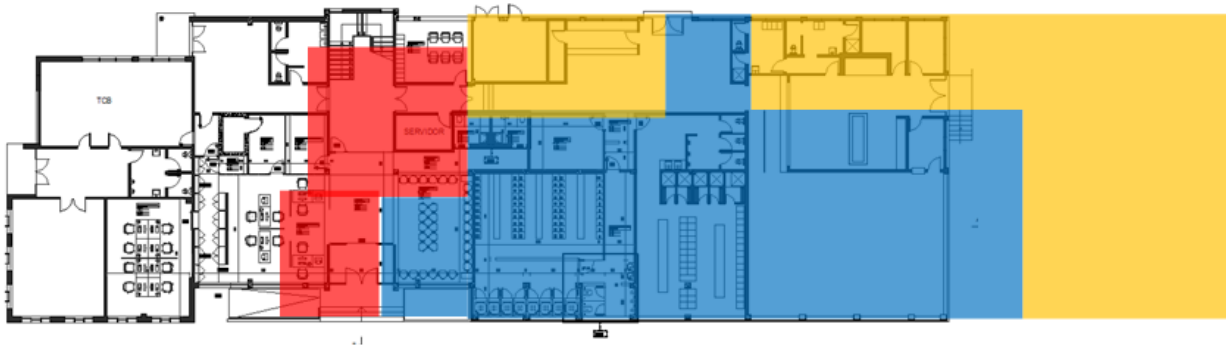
Layout final Departamento de Águas e Resíduos da Câmara Municipal do Barreiro
